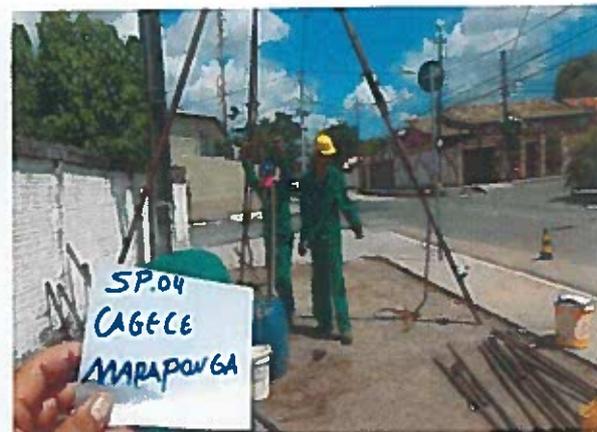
Detalhe da equipe realizando o avanço a trado do furo SP-04.
